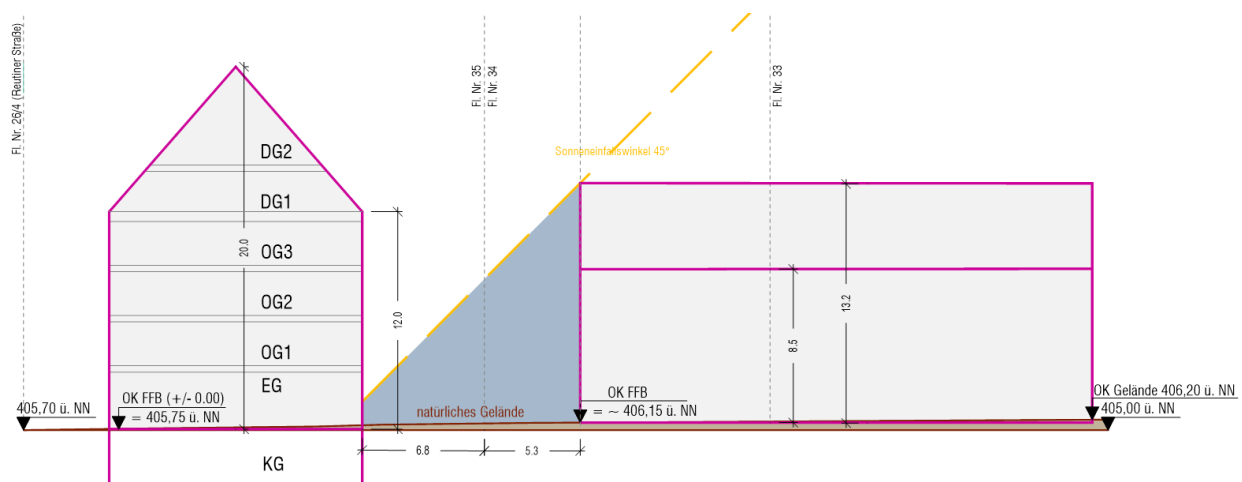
Schematischer Schnitt Nord-Süd zur Betrachtung der Belichtungs- und Belüftungssituation der Bauvorhaben auf den Fl. Nrn. 34 und 35, o. M
